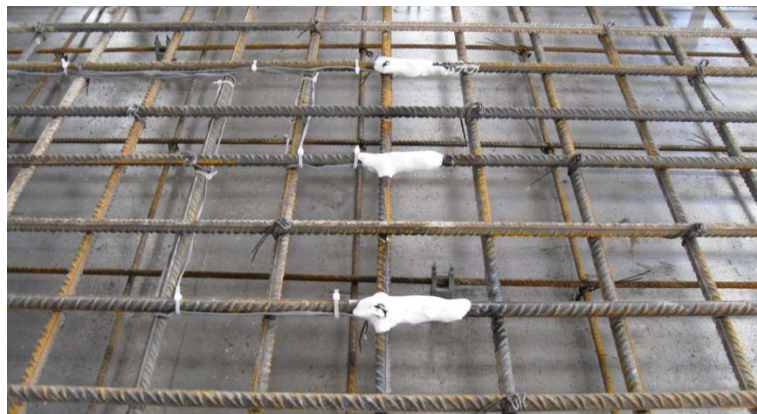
Vista geral da armadura instrumentada e silicone de protecção dos extensómetros
